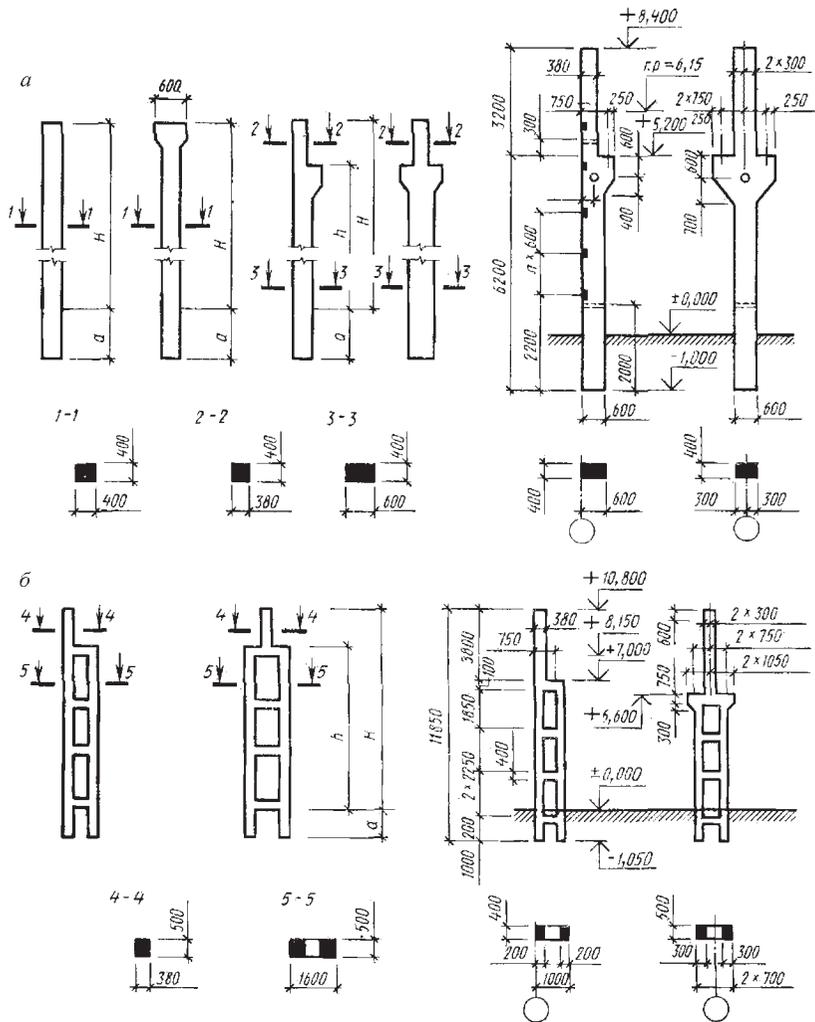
Железобетонные колонны одноэтажных производственных зданий: а – прямоугольного сечения крайние и средние; б – то же, сквозные двухветвевые
